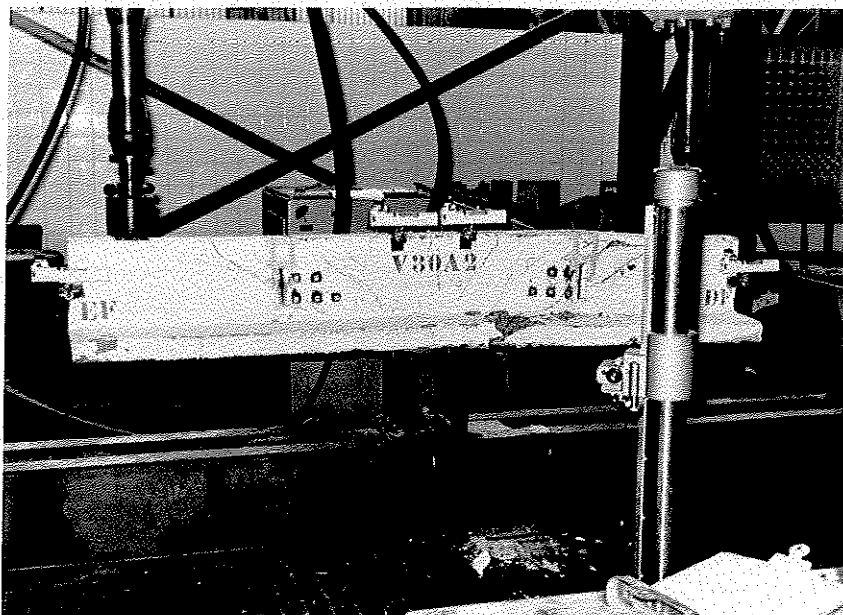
Vista geral da viga V30A* completamente rompida por esforço cortante.
